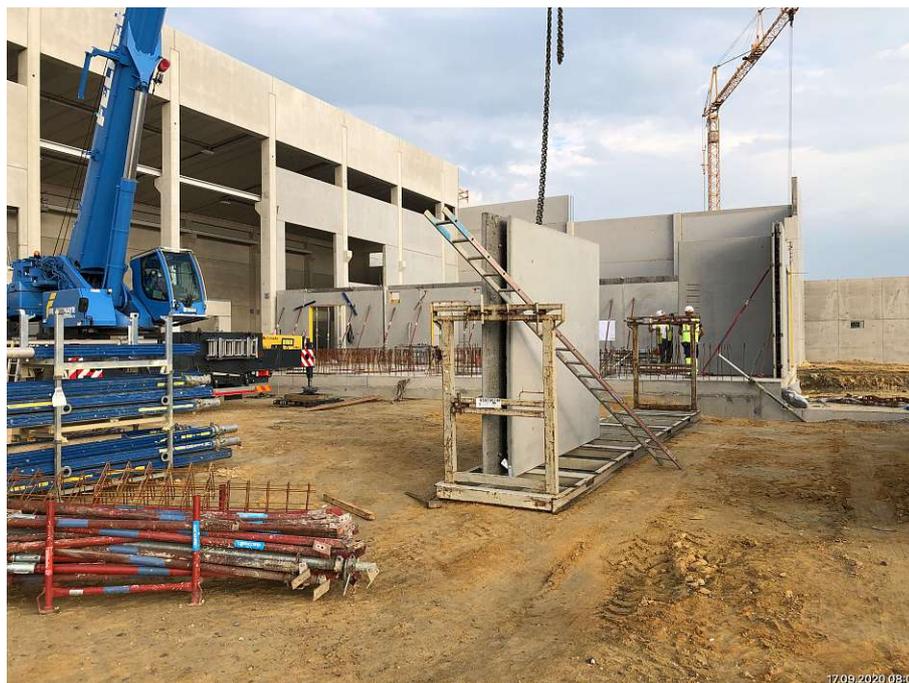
Verwendung von Hohlwänden auf einer Baustelle (Eigene Baustellenaufnahme)
